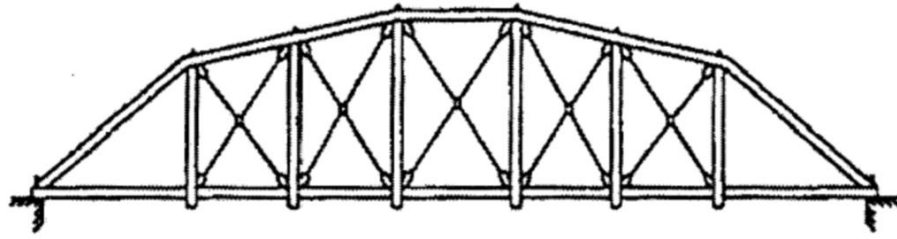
Jembatan Rangka Baja Tipe *King-Post
